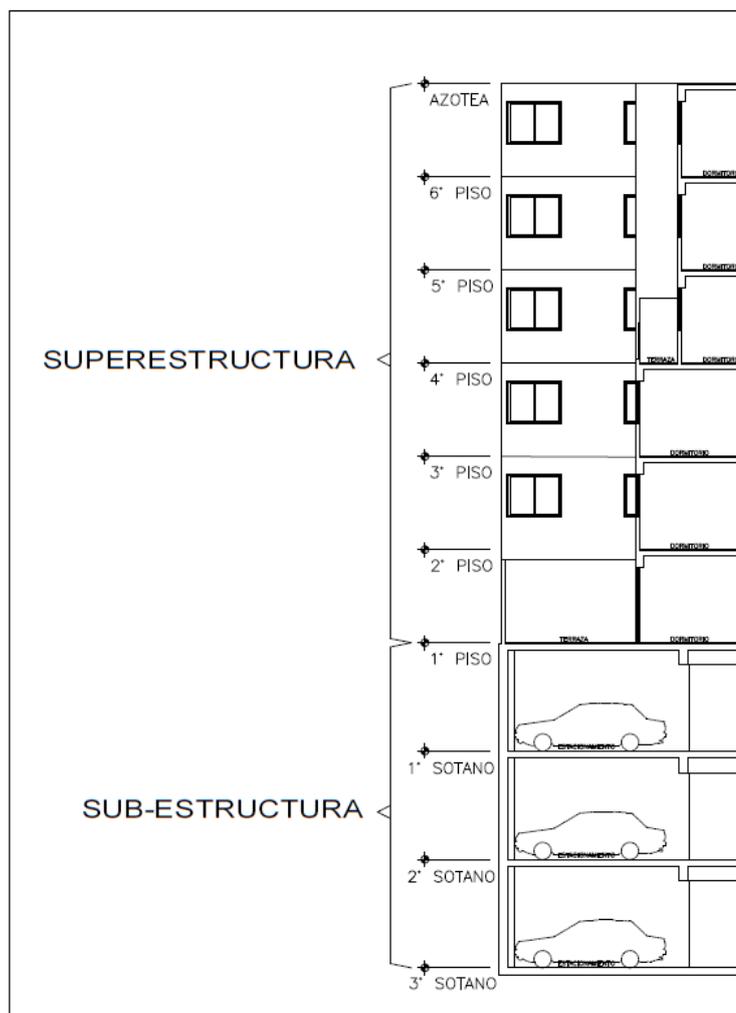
Vista tipo corte de un edificio tipo vivienda multifamiliar típico.
